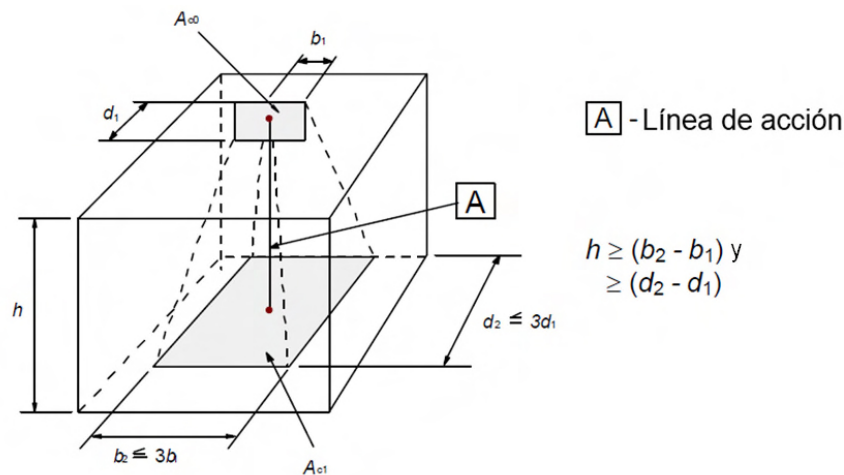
Distribución de cálculo para zonas parcialmente cargadas
